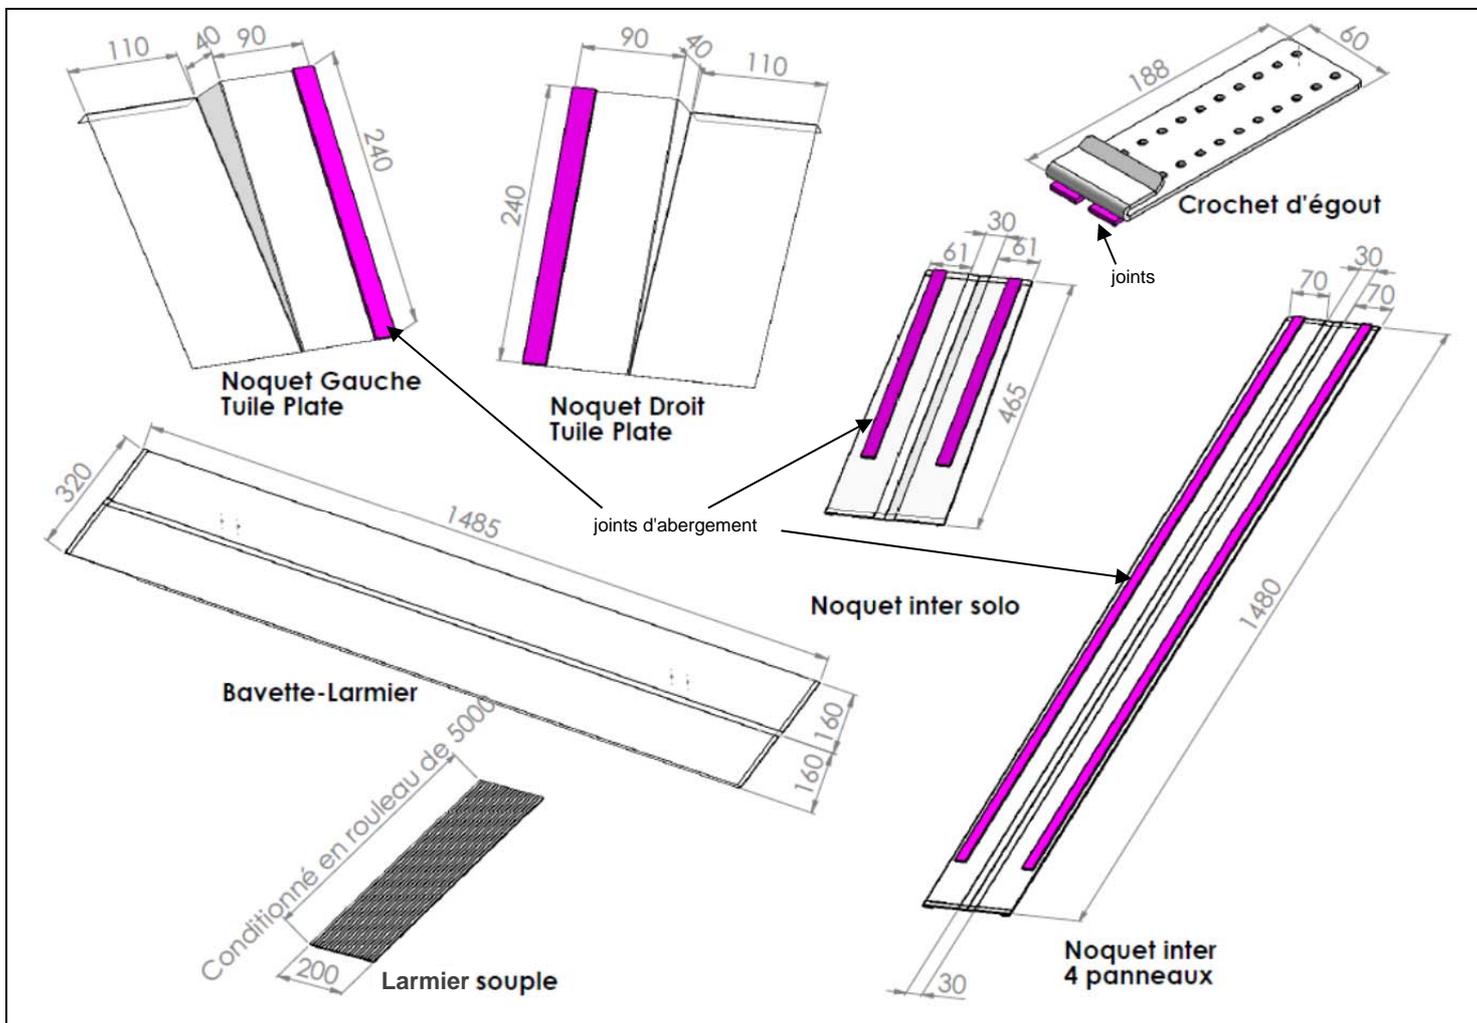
Kit TP (Tuiles Plates 17 x 27) Plan des noquets sur demande si dimensions supérieures
